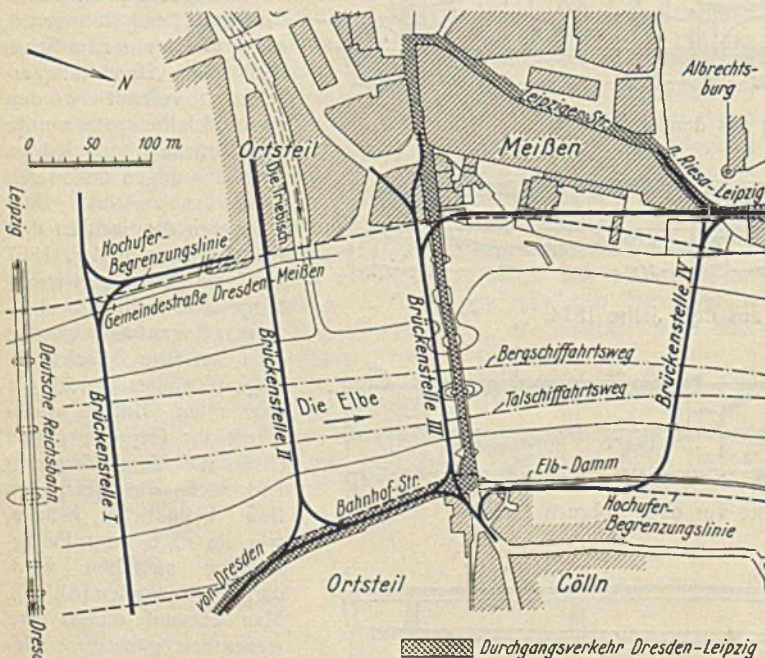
Lageplan mit den verschiedenen in Betracht kommenden Brückenstellen.
